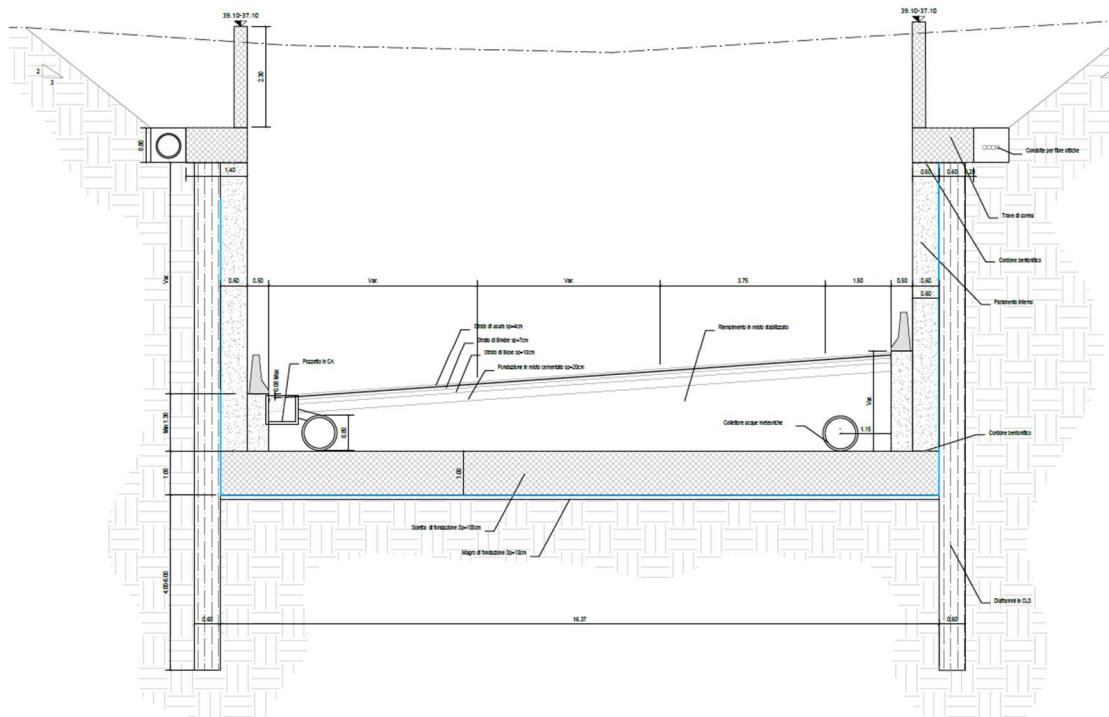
Scavo con diaframmi – sezione TIPO 3
